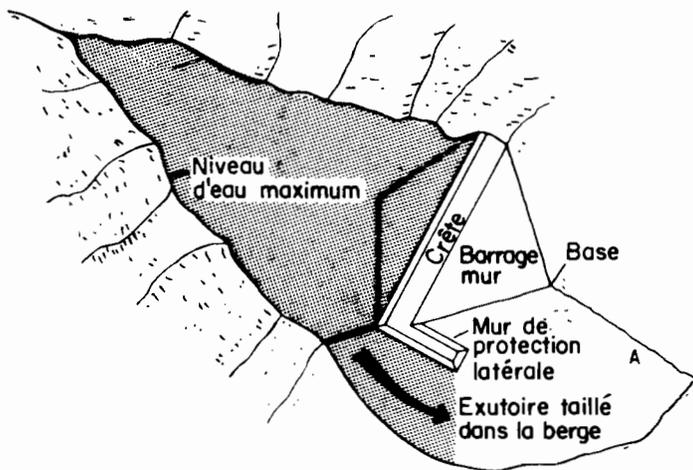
plan d'un petit barrage en terre avec un exutoire en déblais
